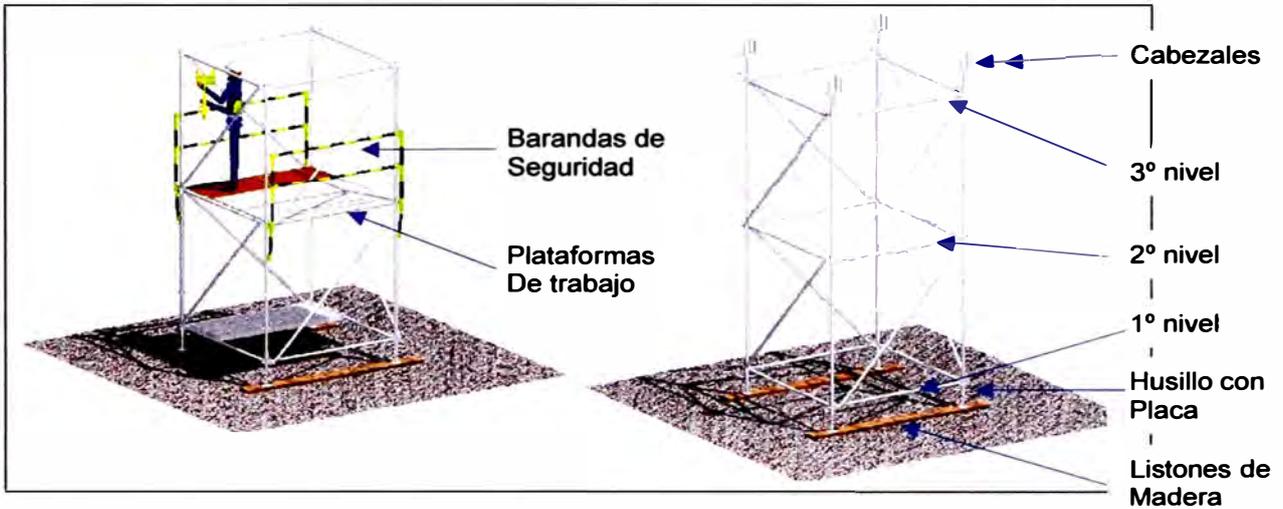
Montaje de 3<sup>er</sup> nivel de elementos horizontales y cabezales.
